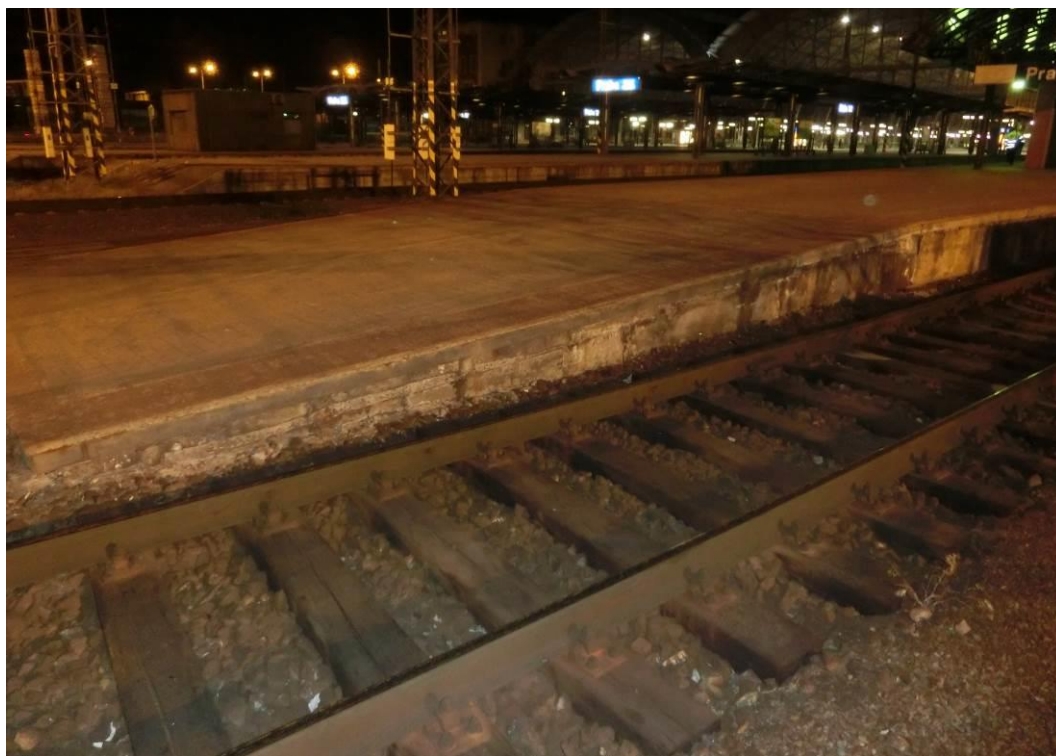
Degradace krycí vrstvy betonu pod ocelovým úhelníkem
